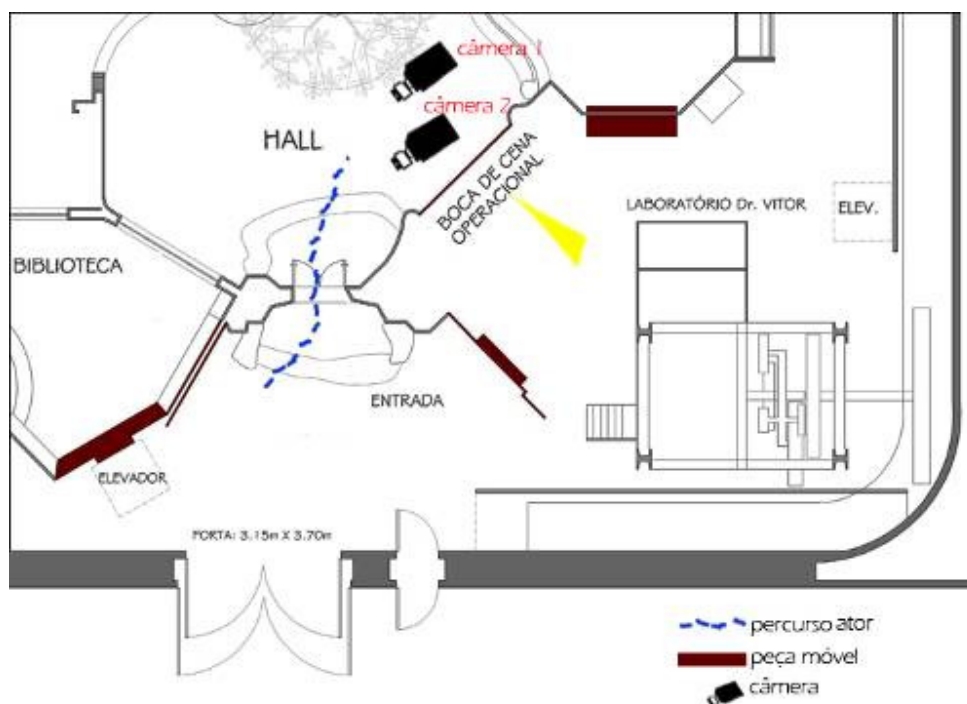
Detalhe em planta do posicionamento de câmeras para cena interna
